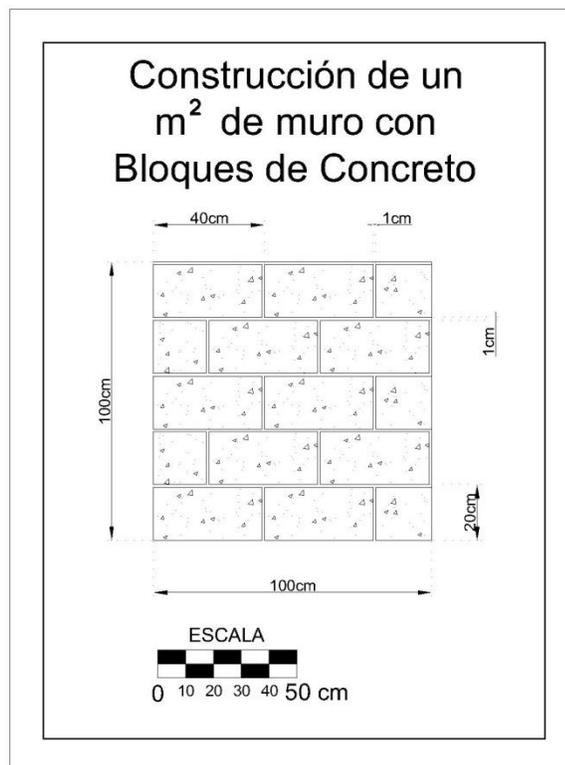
Construcción de un m^2 de muro con Bloques de Concreto.
